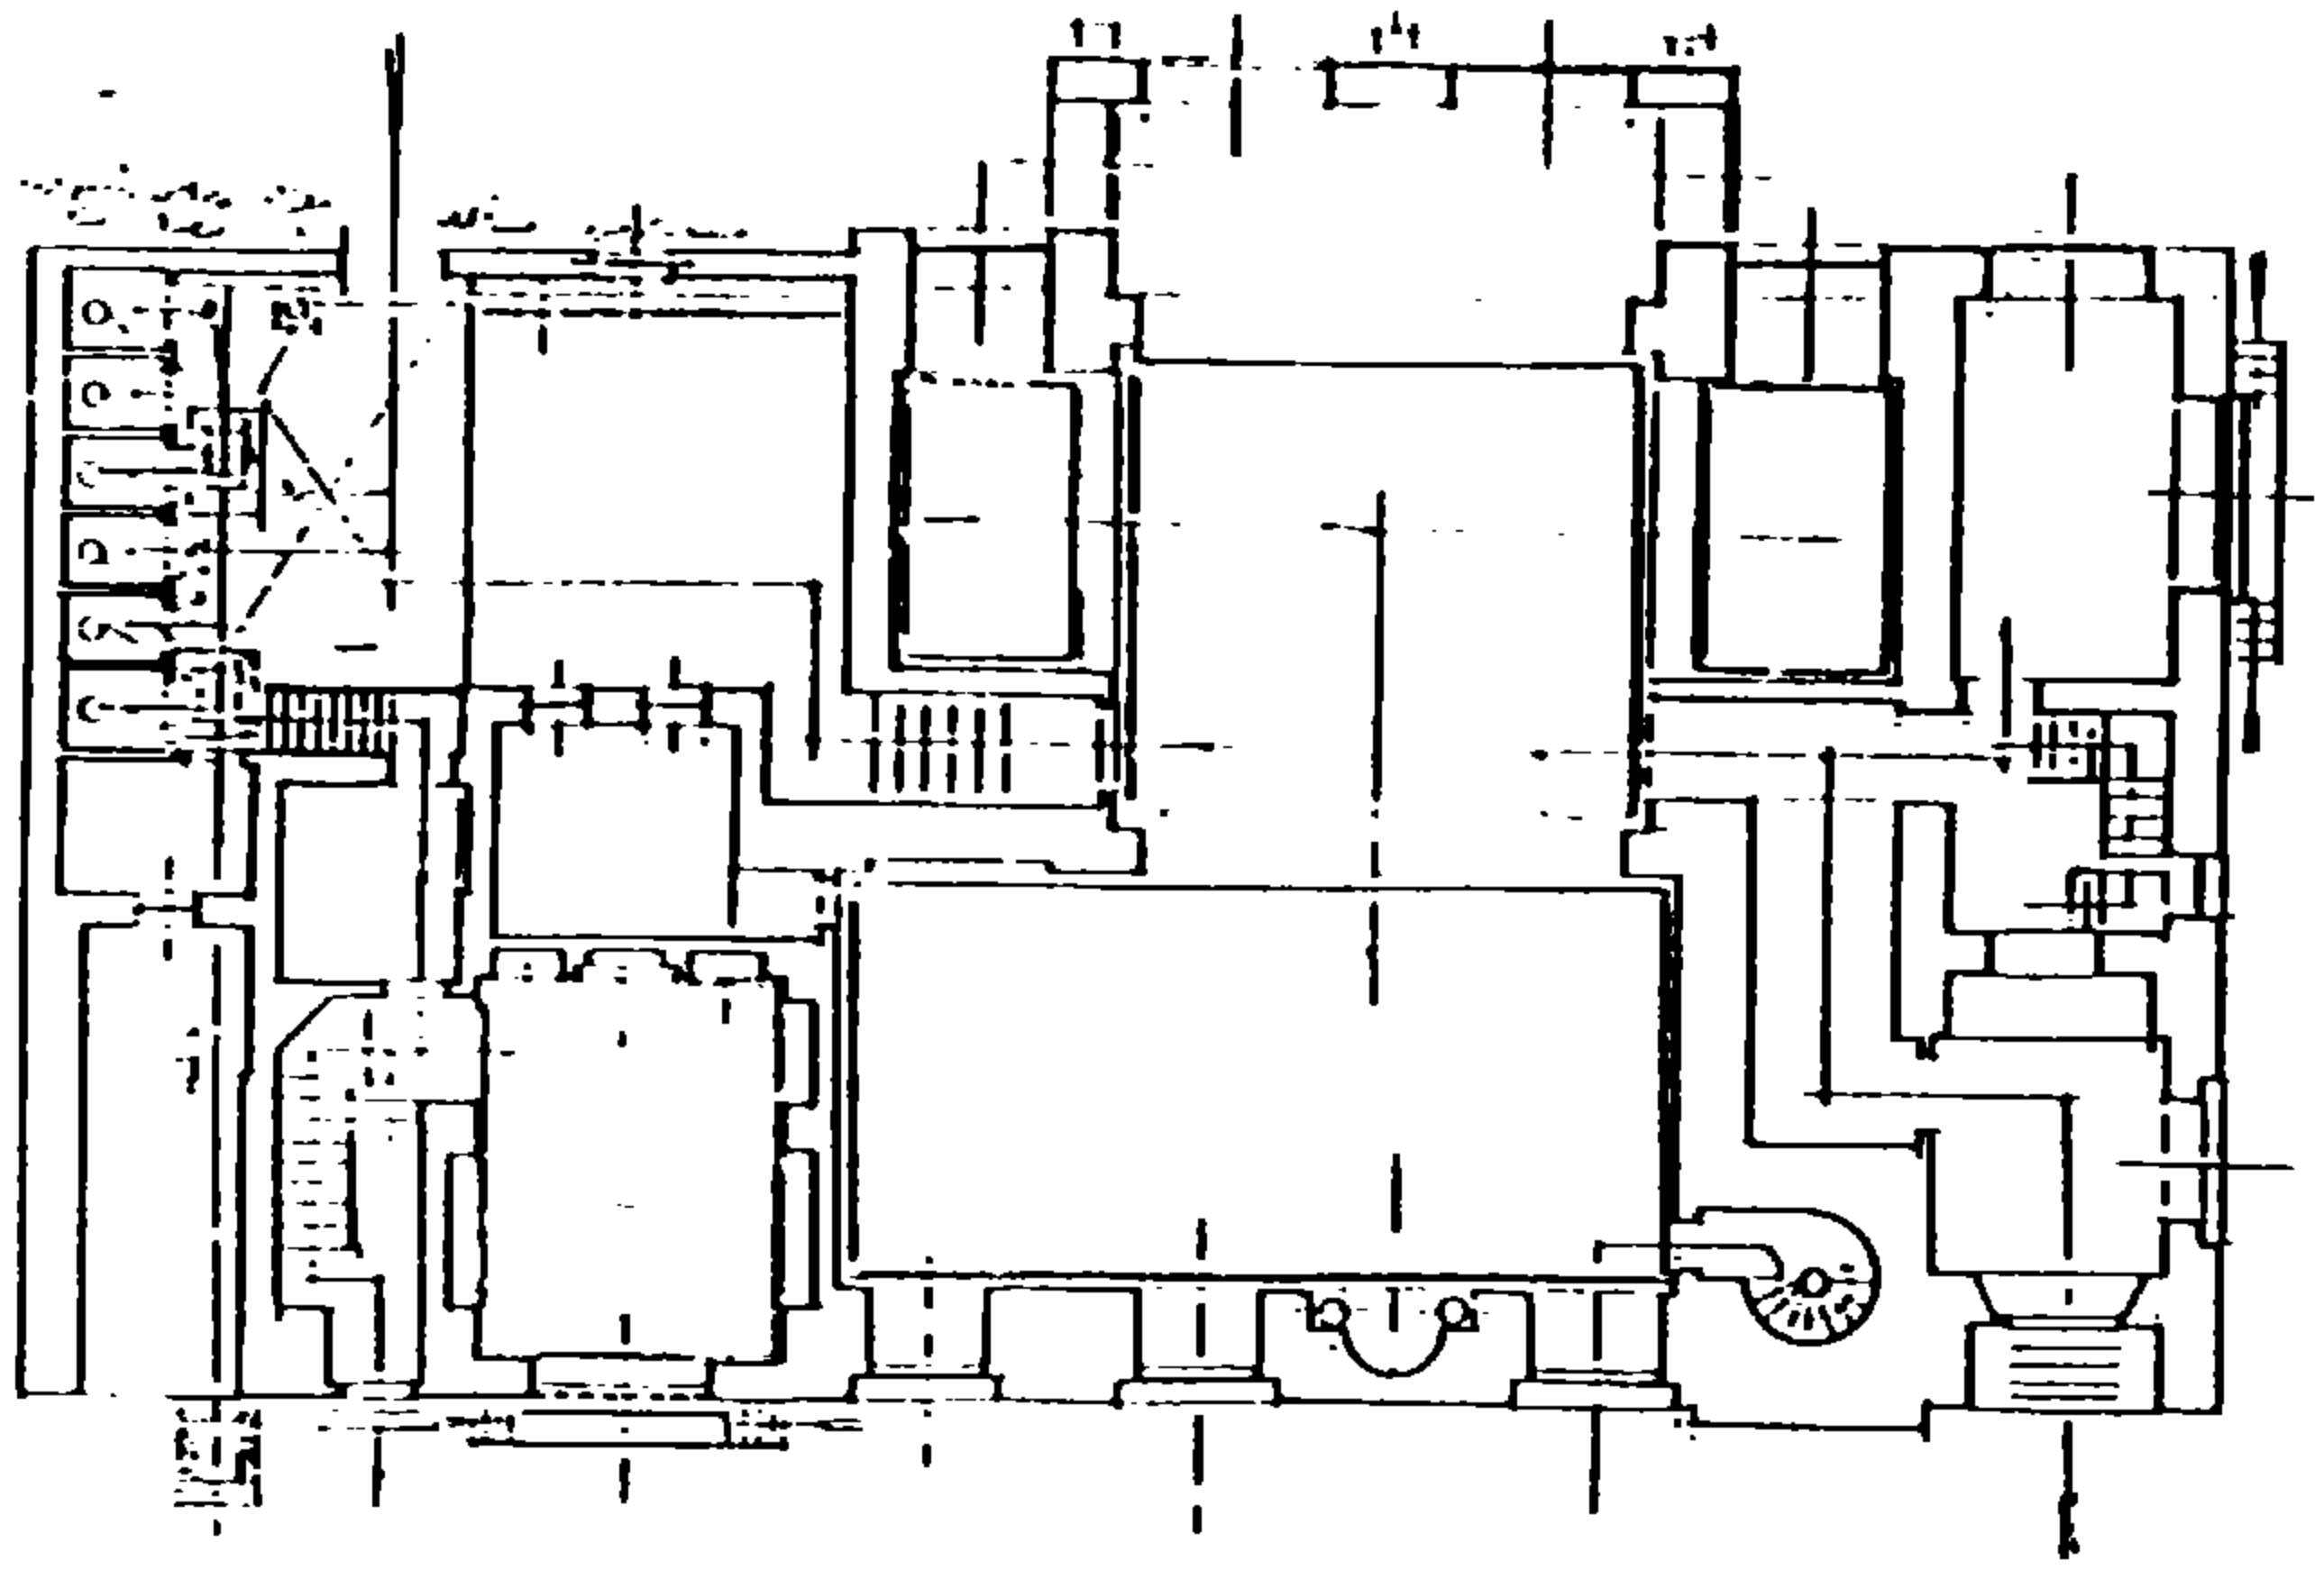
المسقط الأفقى لجامع البردنبى
